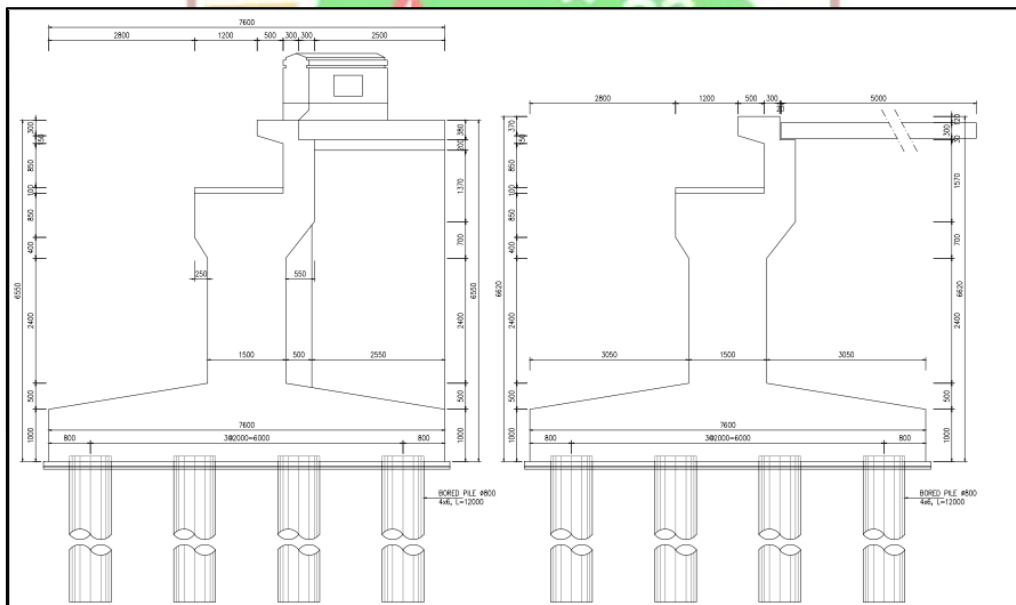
Potongan Melintang Jembatan Abutment 1
